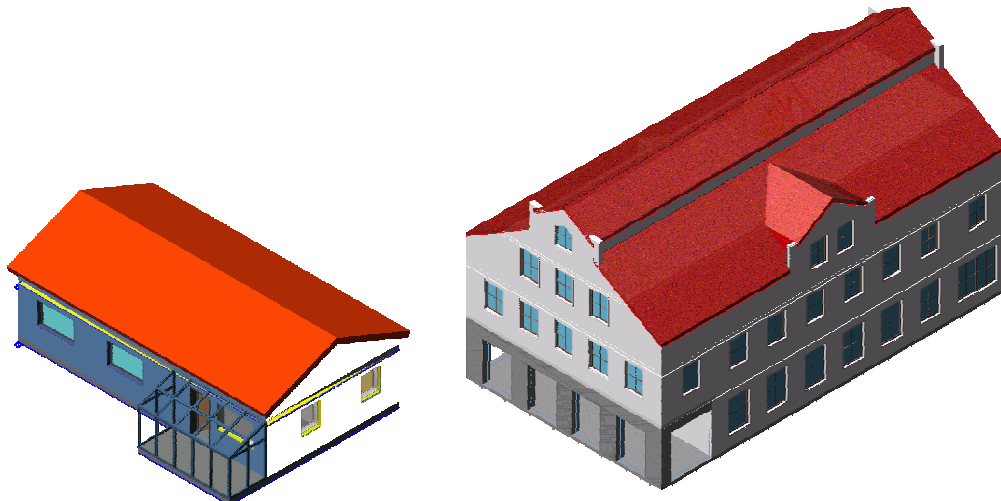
Ergänzung der Trainingsbasis um Objekte anderer Bauwerkstypen, beispielsweise Einfamilienhaus und Altbau, deren Bauteile deutlich anders ausgeprägt sind
